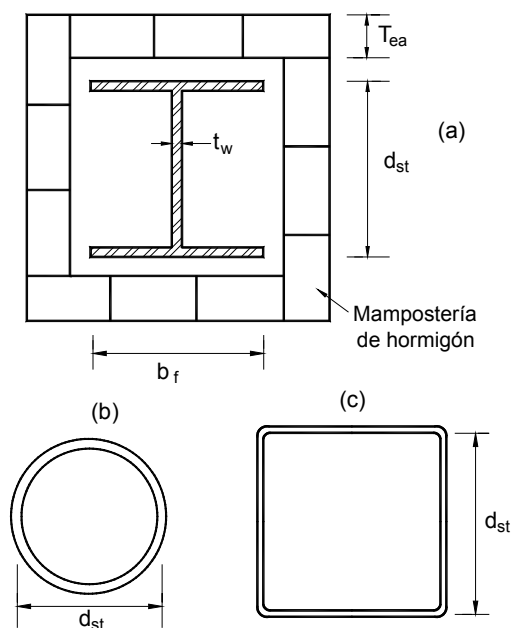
Perfiles de acero estructural protegidos mediante mampostería de hormigón
